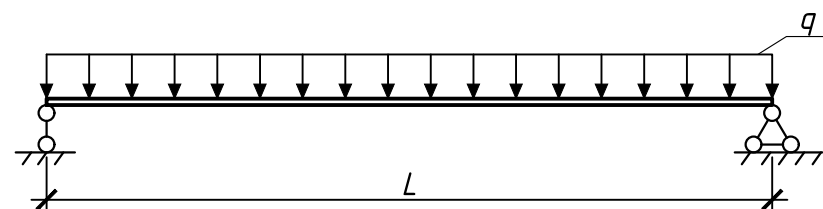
Схема испытаний плиты равномерно распределенной нагрузкой
